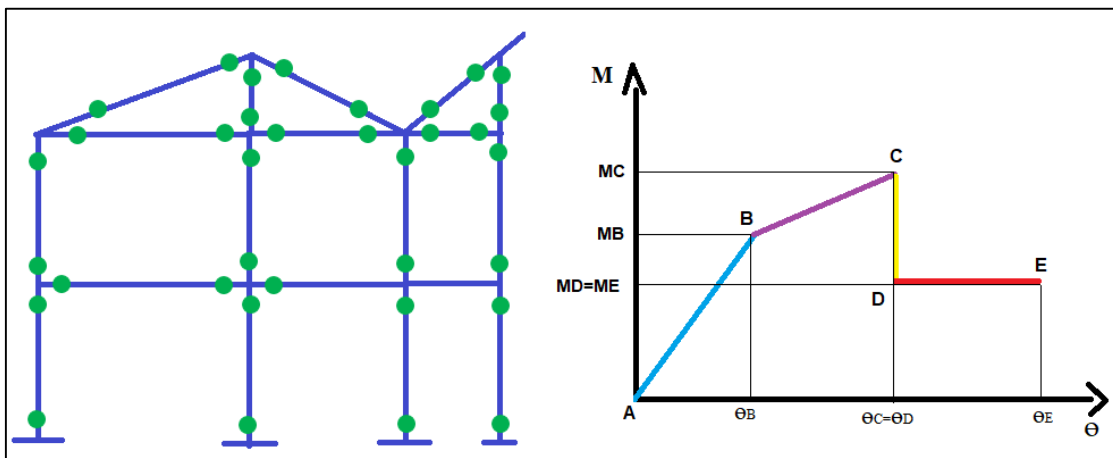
Ilustración de las rotulas plásticas en las estructuras
